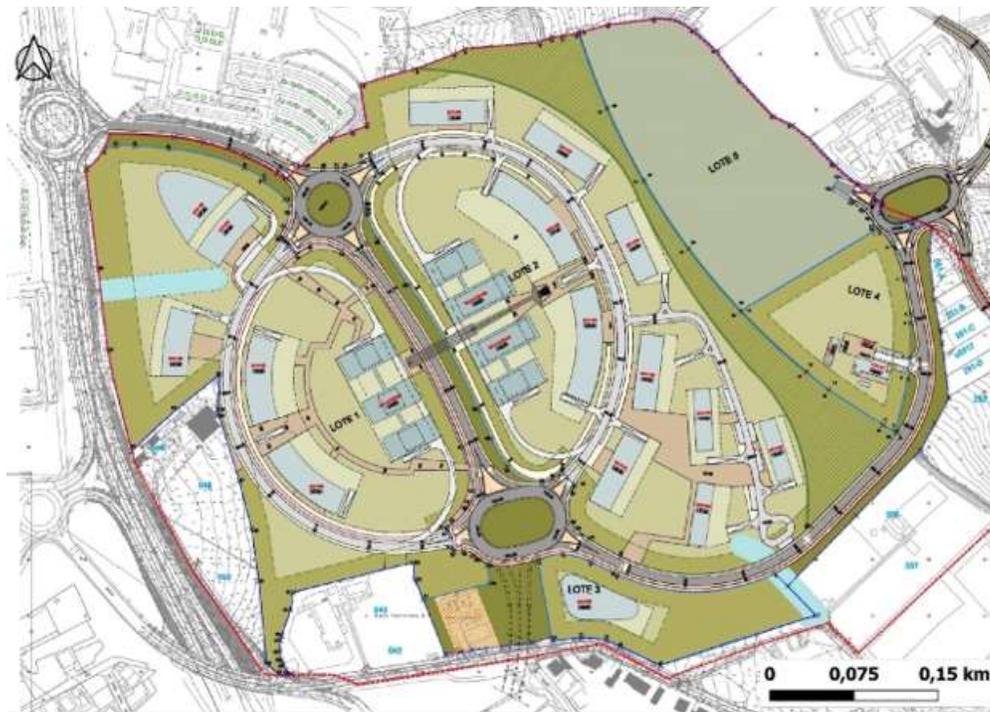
Planta de Cedências (Fonte: JPQV 2021)
